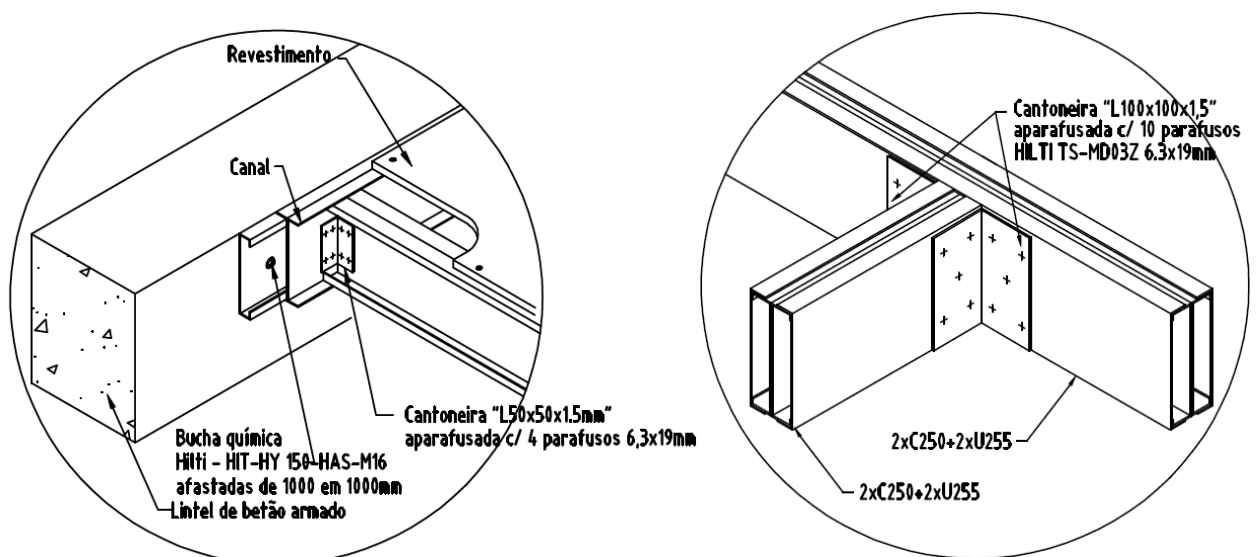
Pormenores de ligação entre perfis de viga por meio de cantoneiras aparafusadas nos encontros: Esquerda- situação de reabilitação /solução mista betão – LSF; direita- ligação entre lintéis, solução LSF
